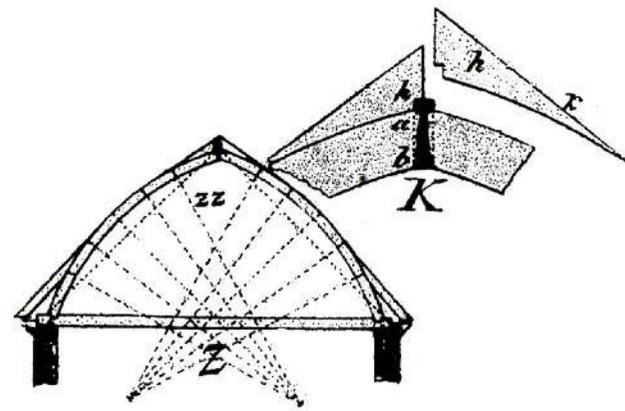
Bohlenbinderkonstrukt. von Gilly und Firstbohle nach Langhans
